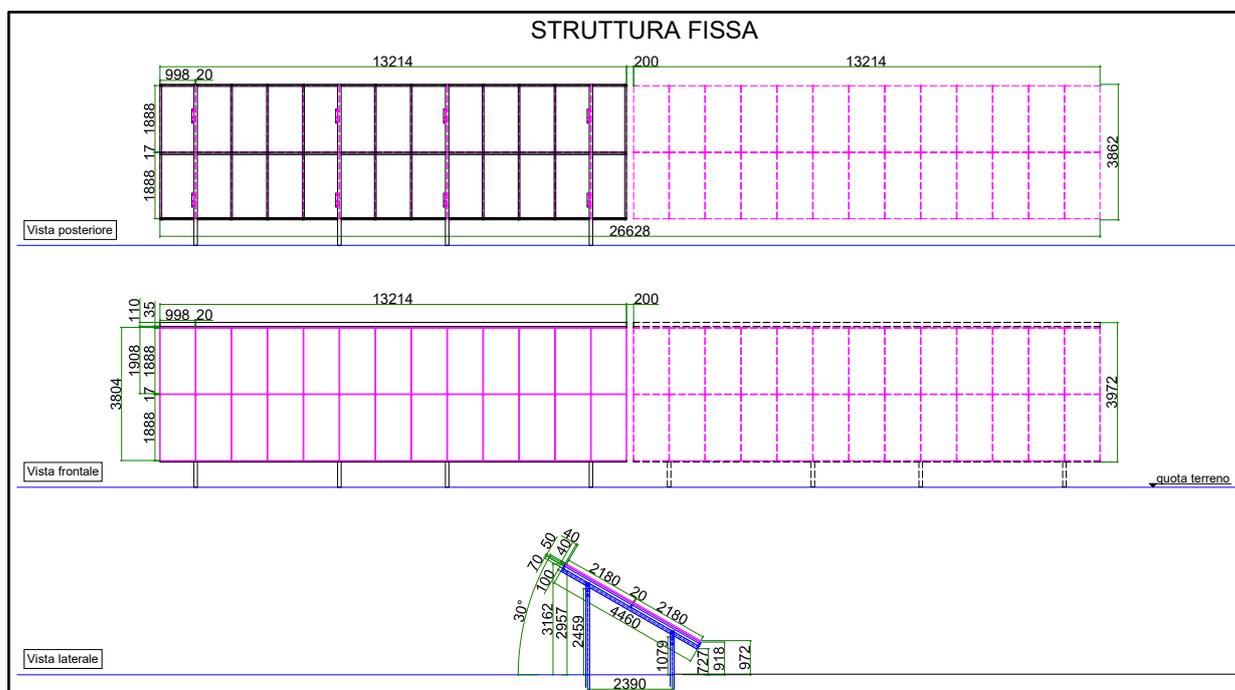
Rappresentazione tipico struttura si supporto – tipo fisso
